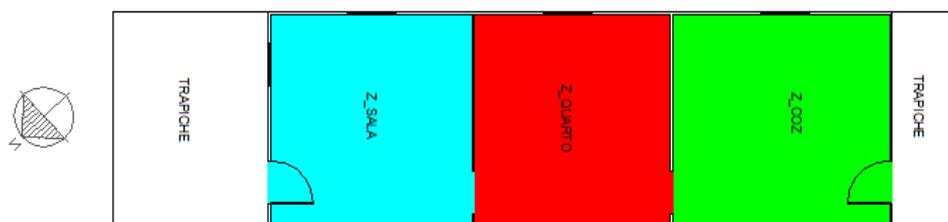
Planta baixa em zonas térmicas da tipologia palafita rural leste
